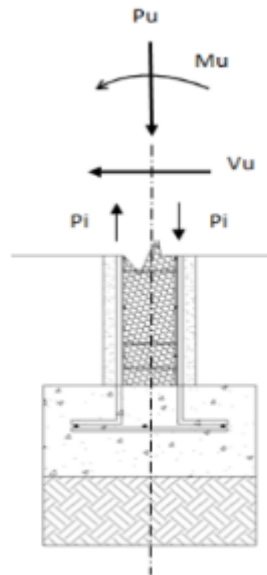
Planteamiento teórico para el cálculo de las longitudes de anclaje de los paneles EMMEDUE a la cimentación.
